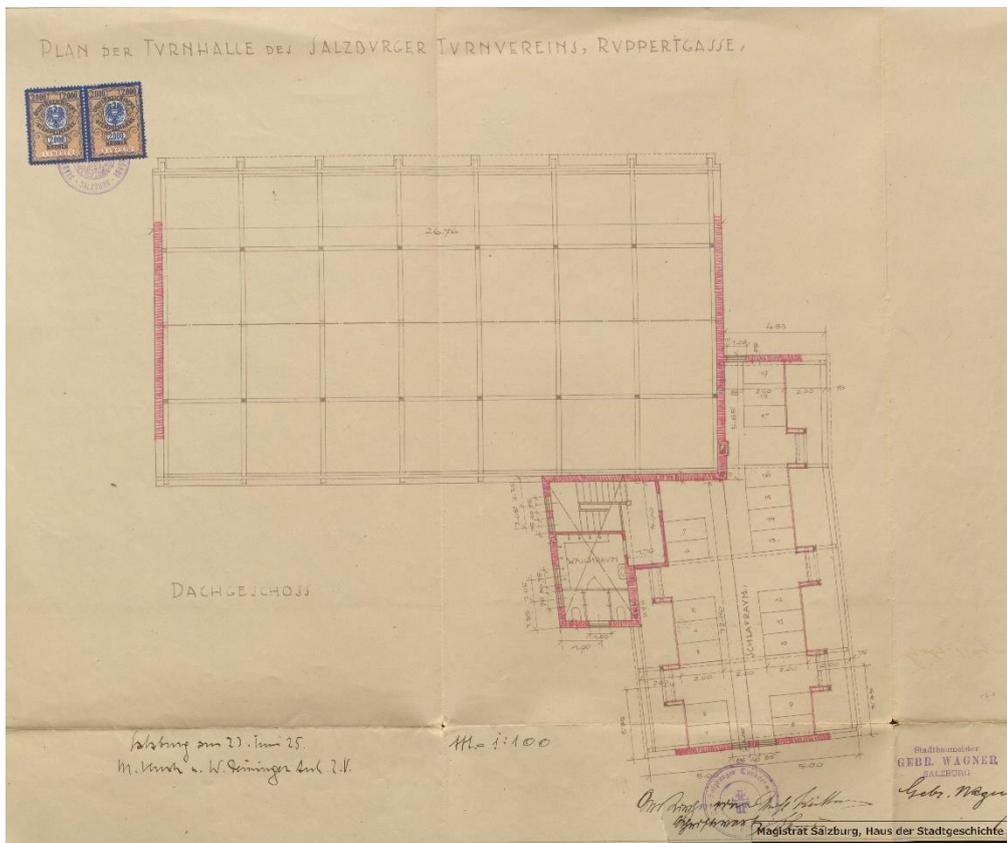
Einreichplan Dachgeschoss 1925 © Architekt Daininger und Stadtbaumeister Gebr. Wagner
